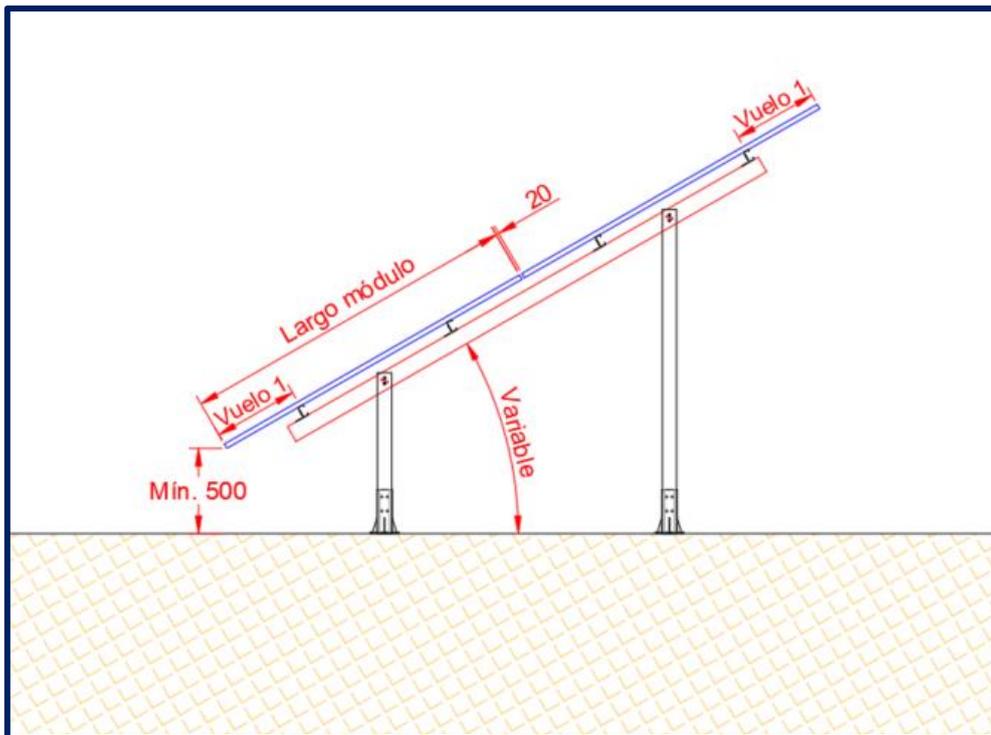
Dimensiones principales del pórtico de la estructura.
